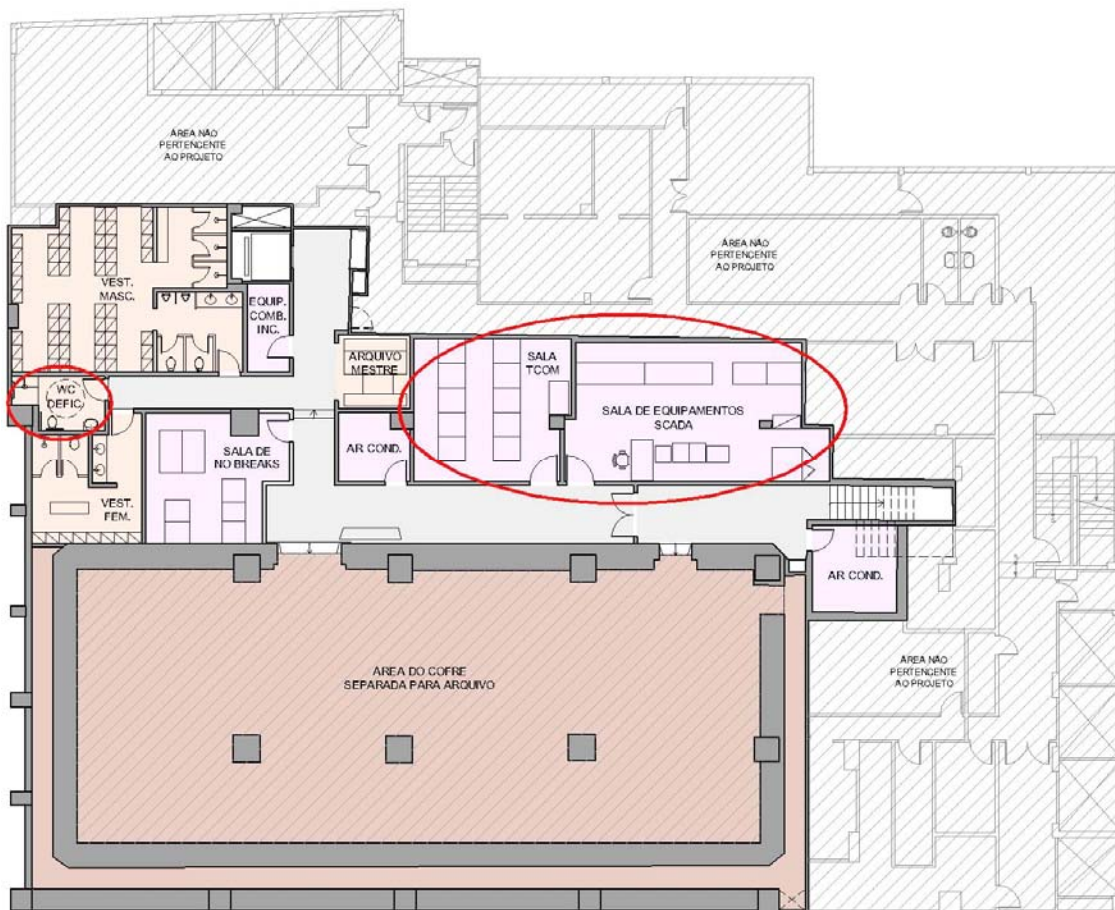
Planta baixa subsolo: layout apresentado à diretoria (quatro de julho)
